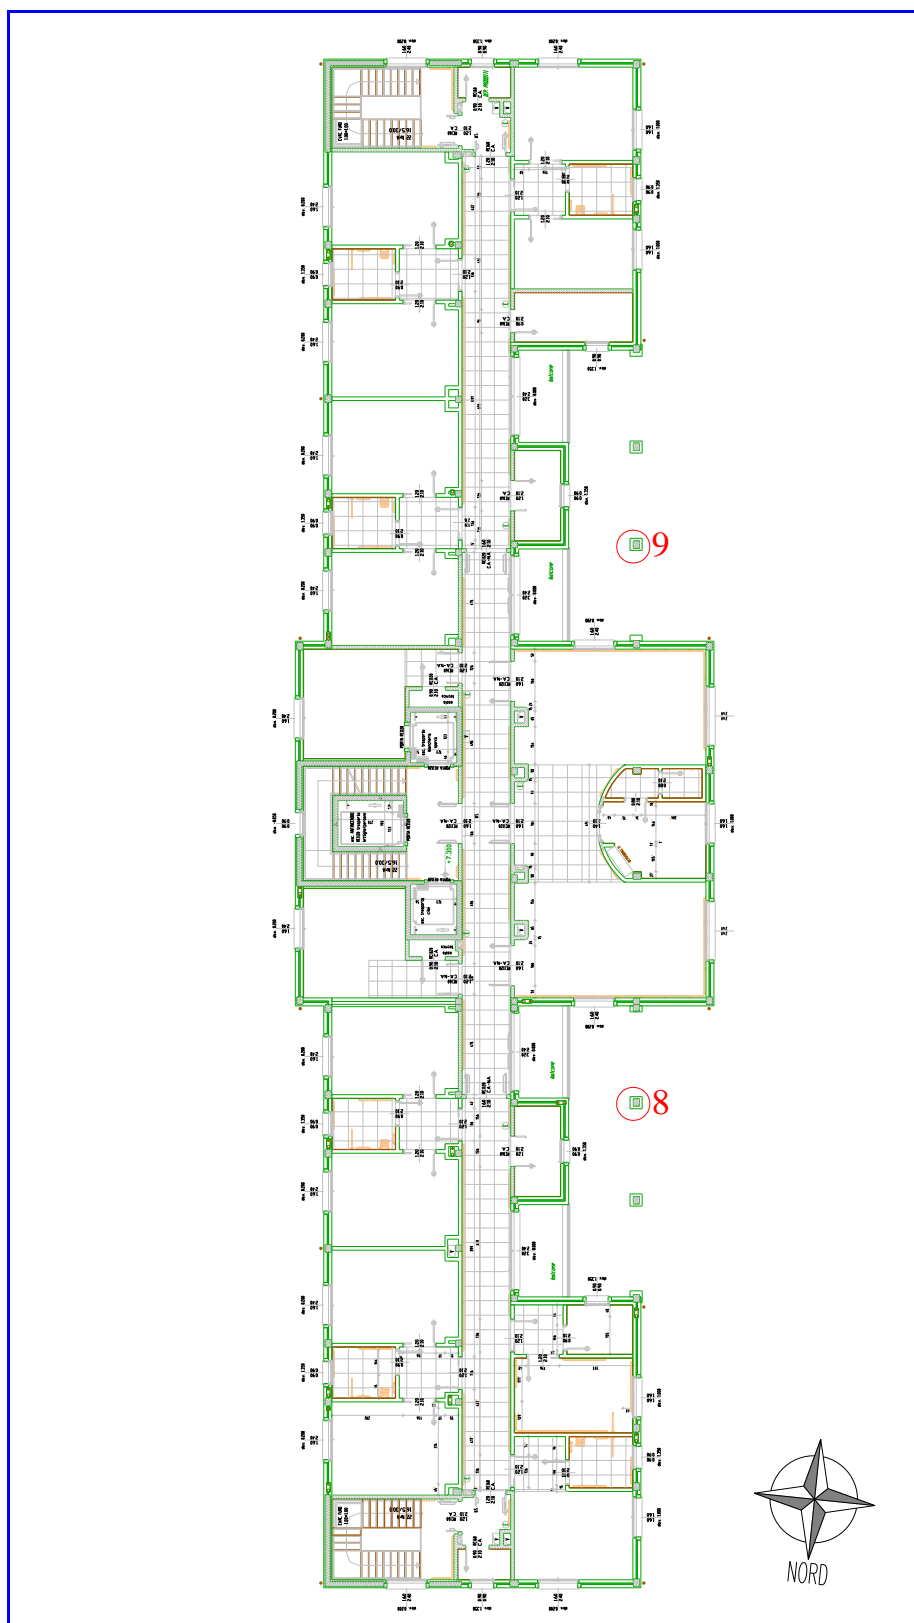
Planimetria secondo piano con ubicazione punti di indagine
